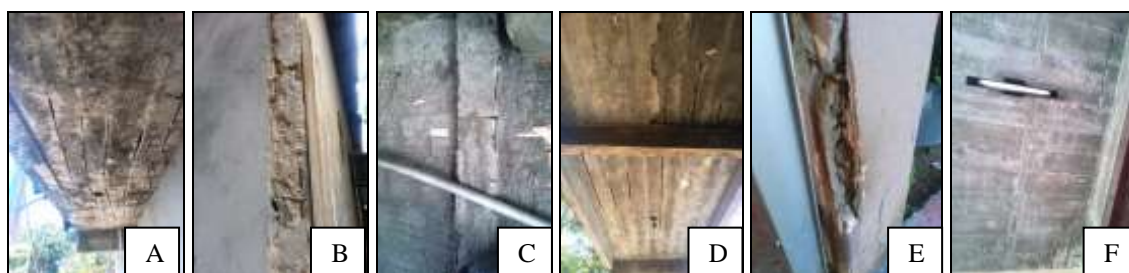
Corrosão de armaduras identificadas em elementos estruturais das edificações em estudo: (A) Laje externa do corredor da Edificação 1, (B) Pilar externo da Edificação 2, (C) Pilar da garagem da Edificação 3, (D) Laje externa da Edificação 4, (E) Pilar externo da entrada da Edificação 5, (F) Laje da sala da Edificação 6
